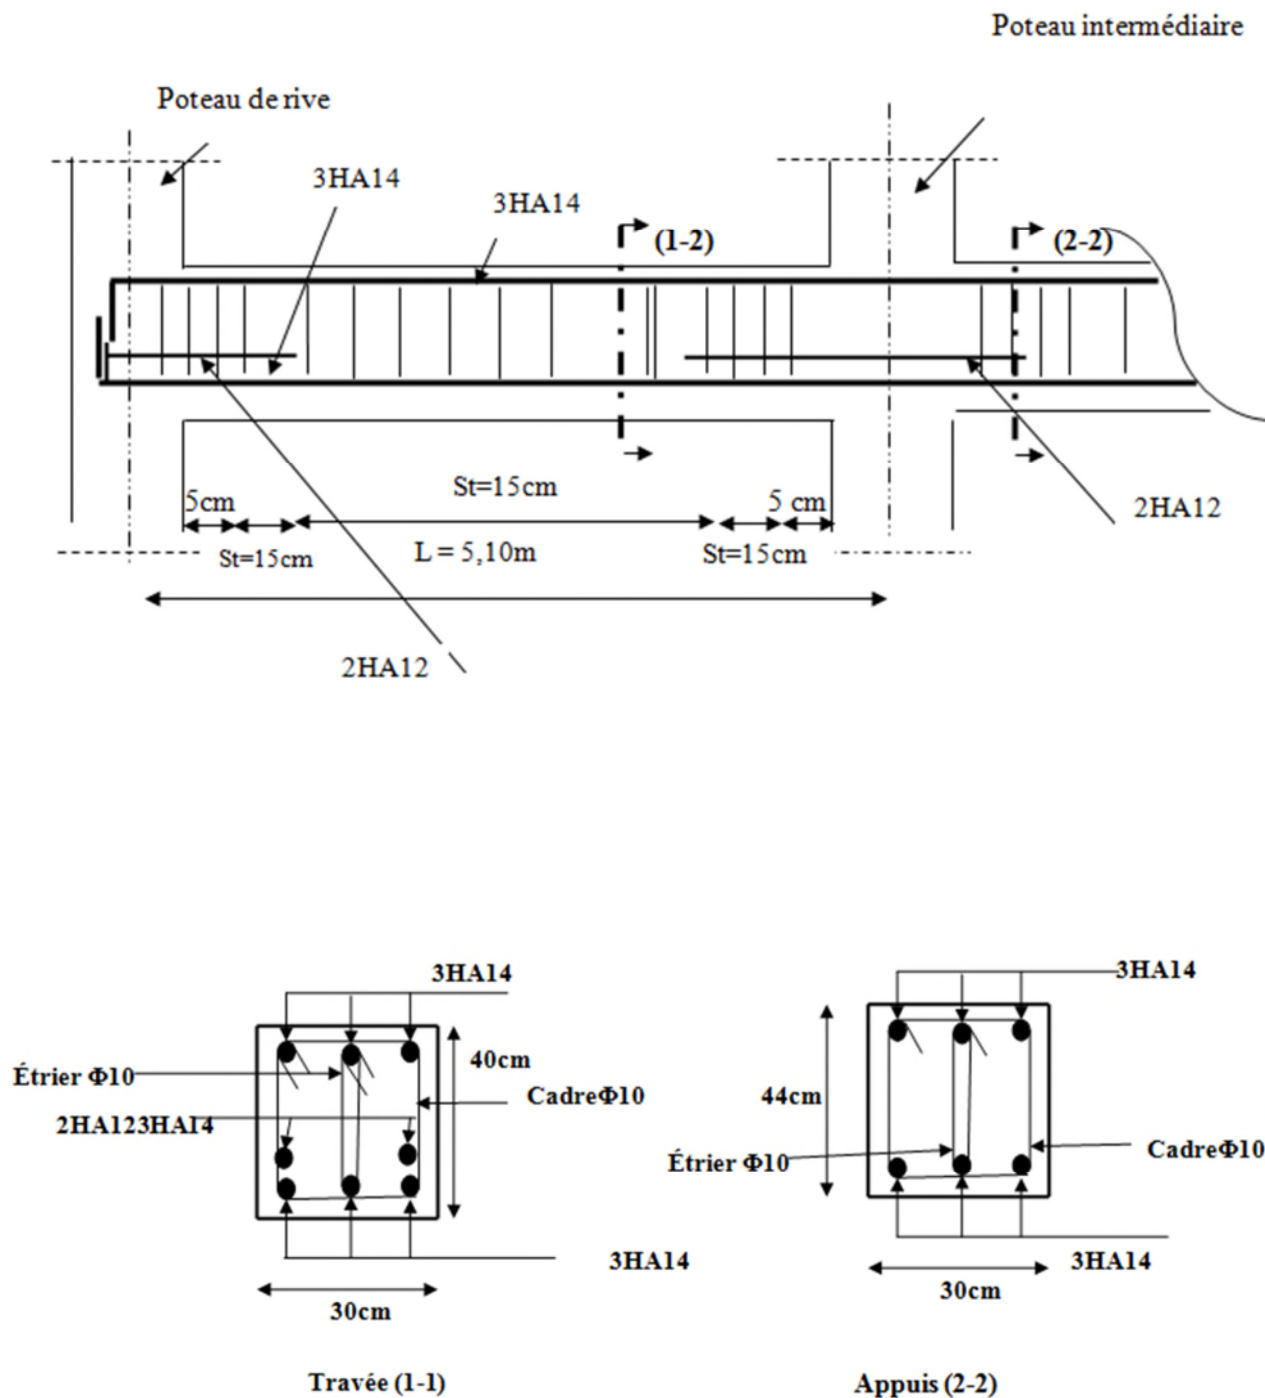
Schéma de ferrailage de la poutre principale (30*40) pour tous les niveaux (du sous sol au 9^{ème} étage + terrasse inaccessible)
